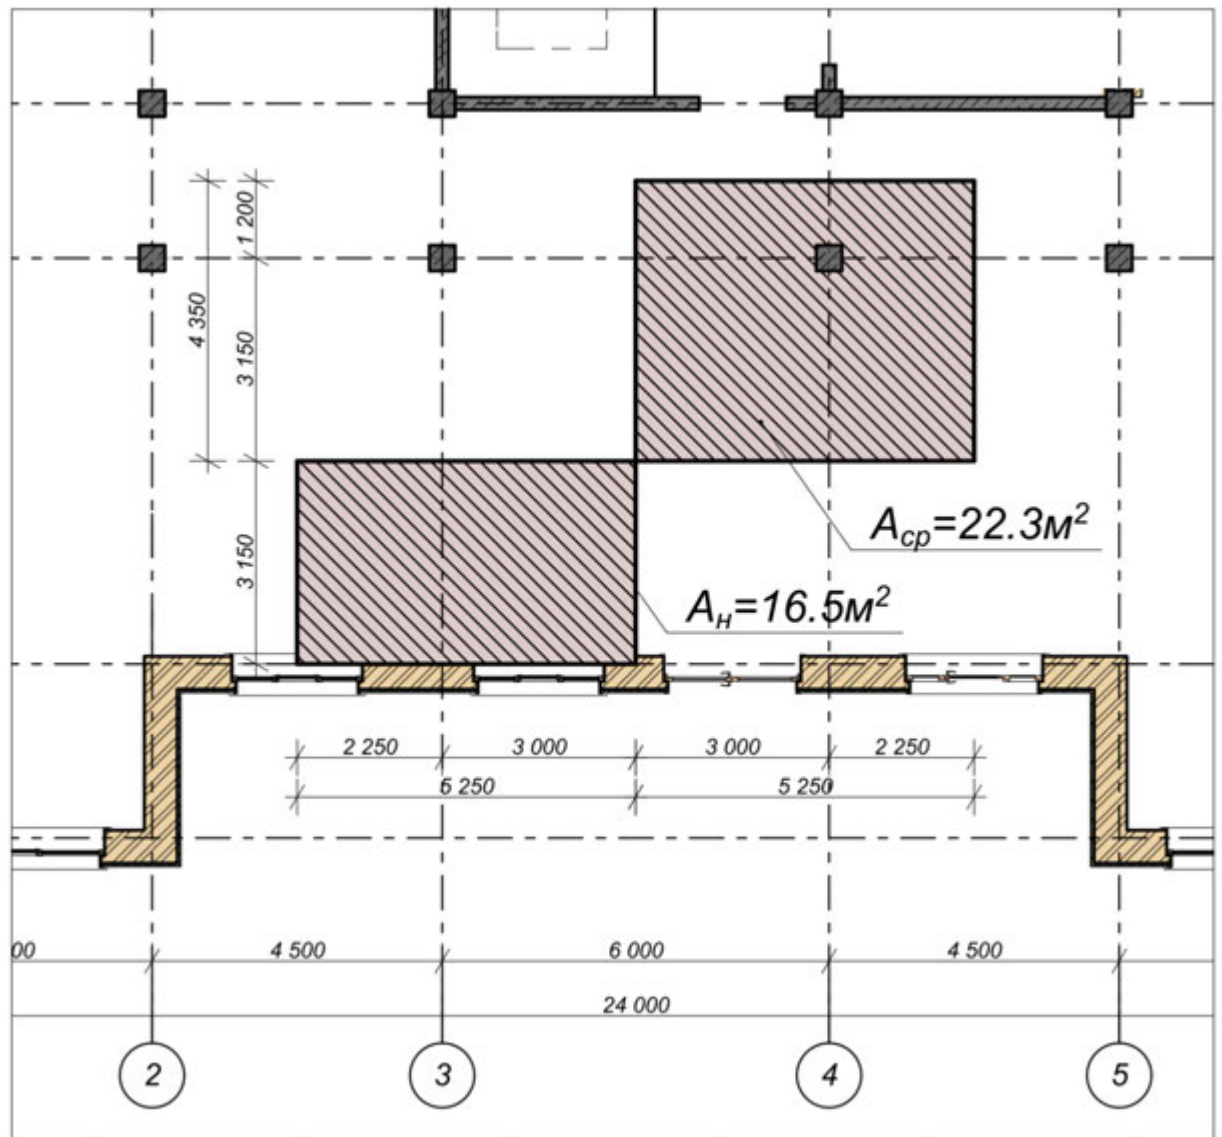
Схематичний план і вантажні площі для фундаментів, що розраховуються.
